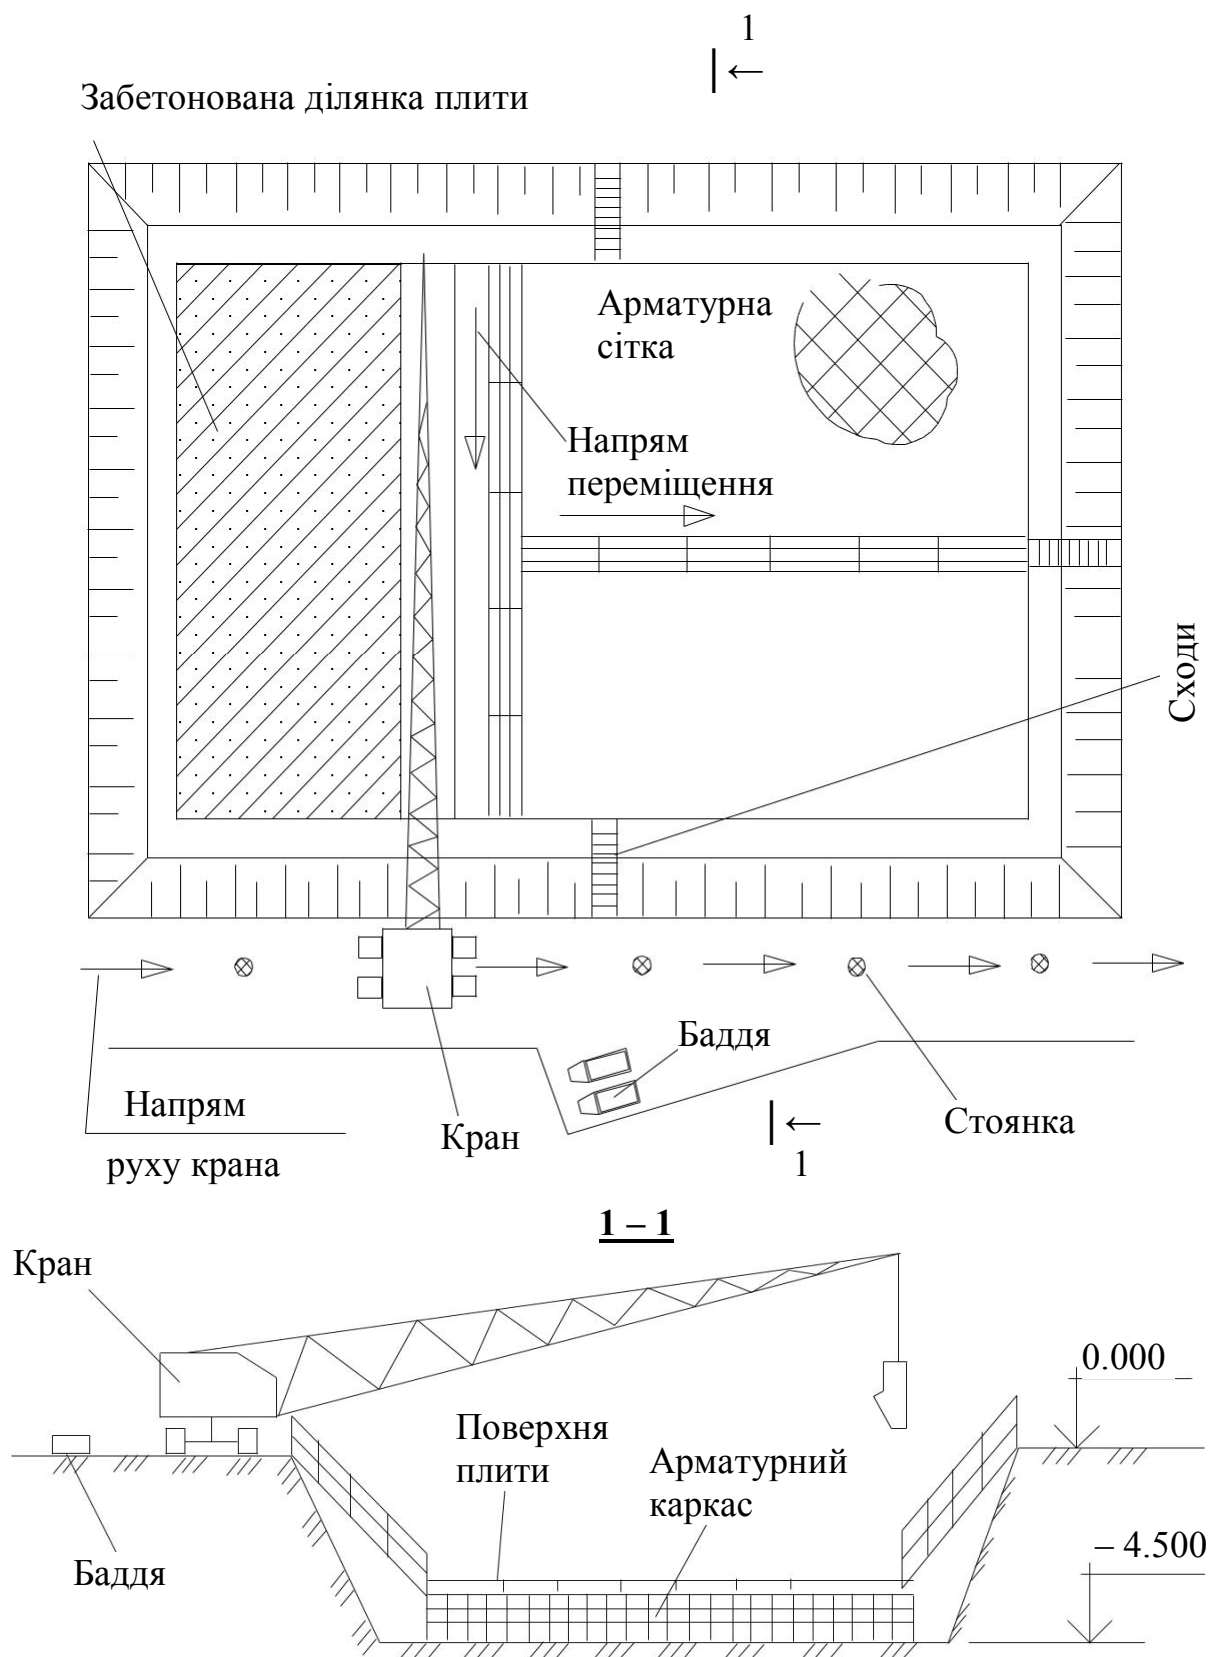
Технологічна схема бетонування фундаментної плити одним краном
